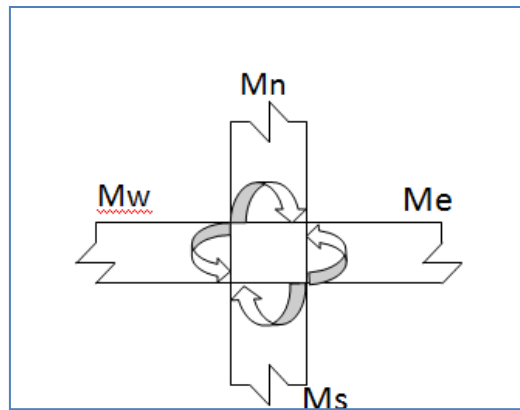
Dimensionnement d'un nœud poutre - poteau
